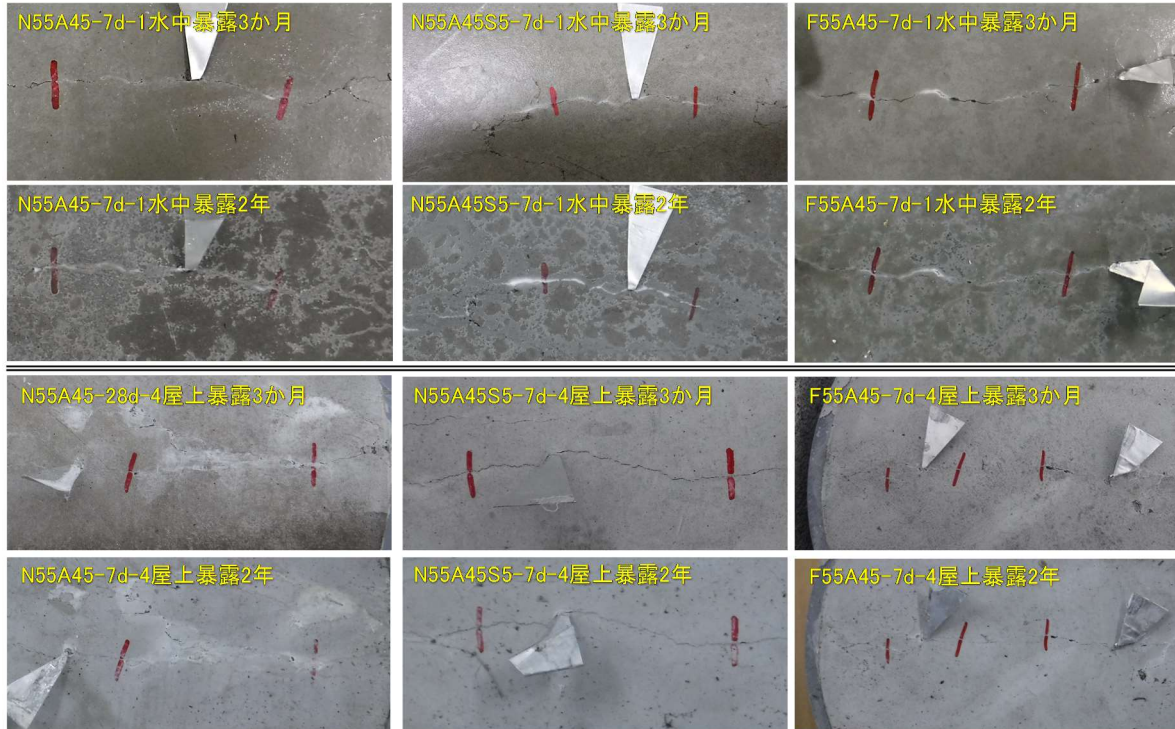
暴露3か月と2年後の底面のひび割れ自己充填状況
